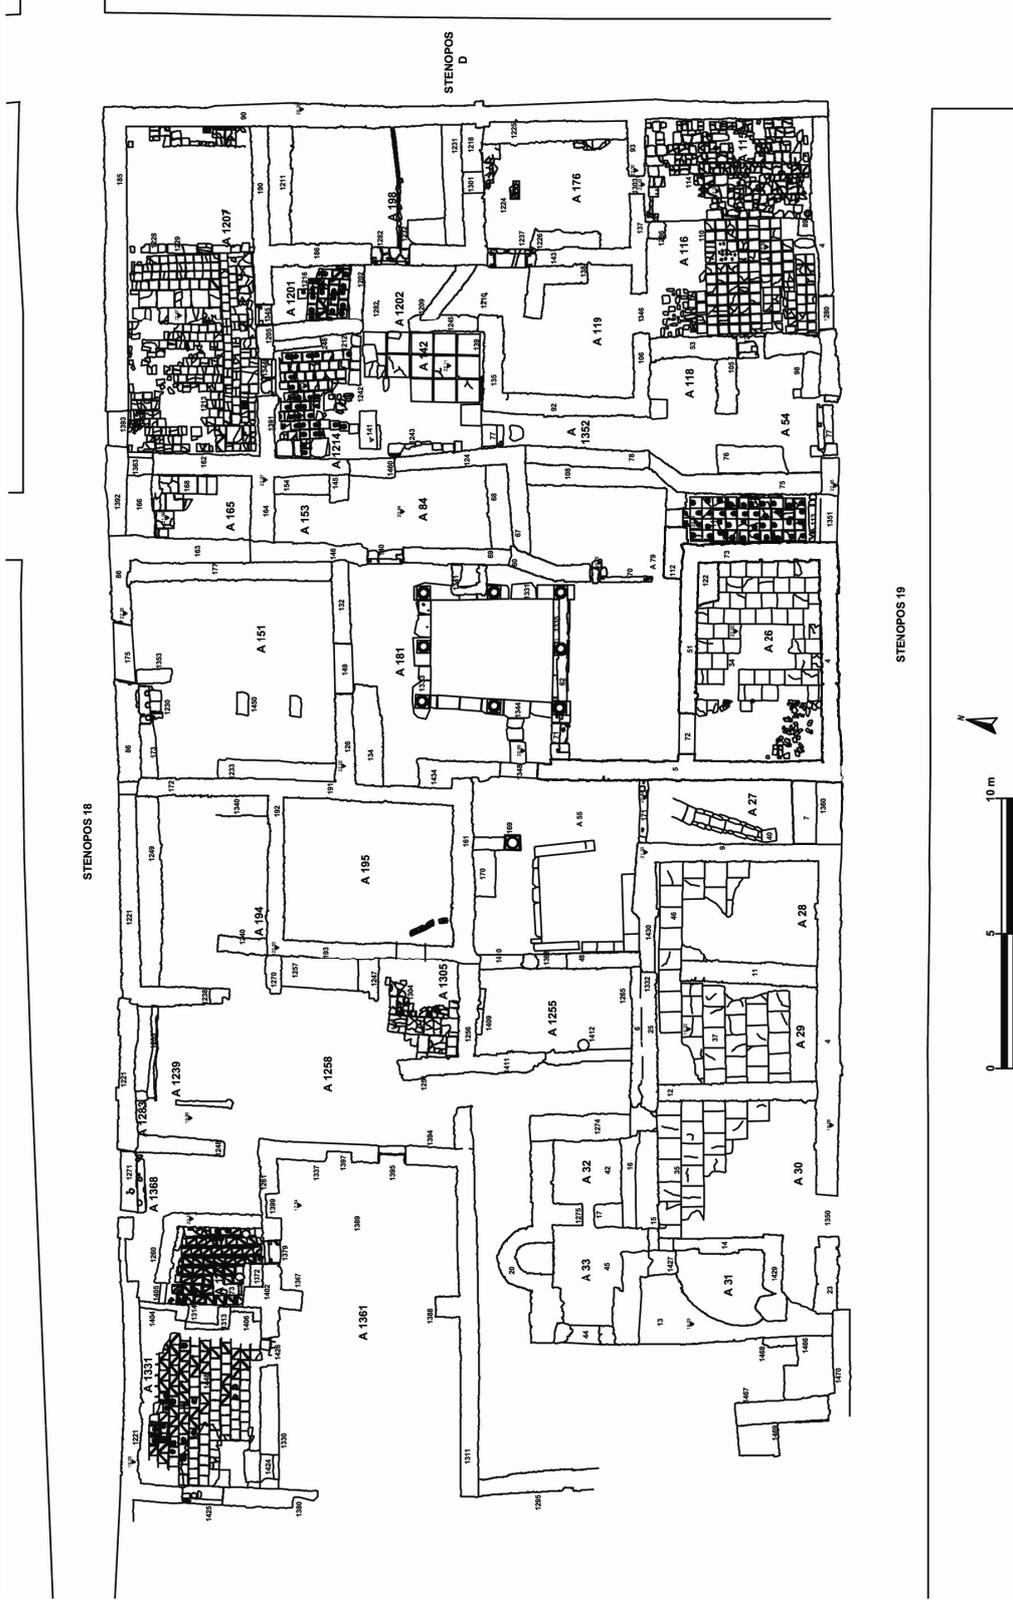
Pianta di distribuzione dei pavimenti in tavelle.
